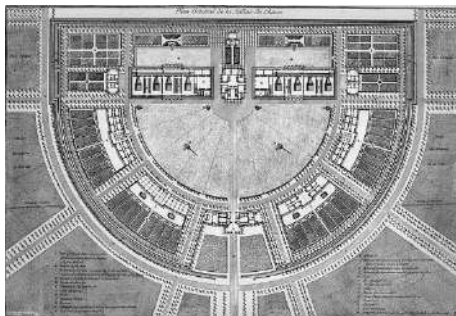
Plan de la Saline Royale d'Arc-et-Senans
